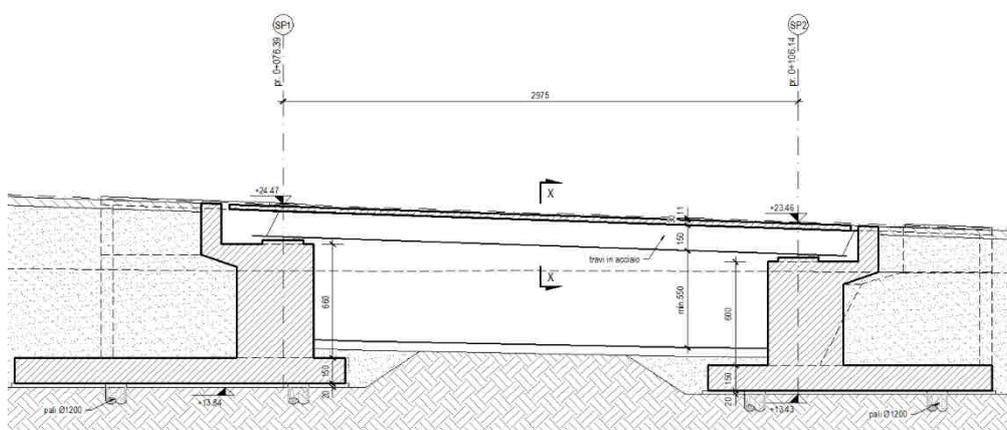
Sezione longitudinale – Sottovia svincolo SS.125 – rampa 5
